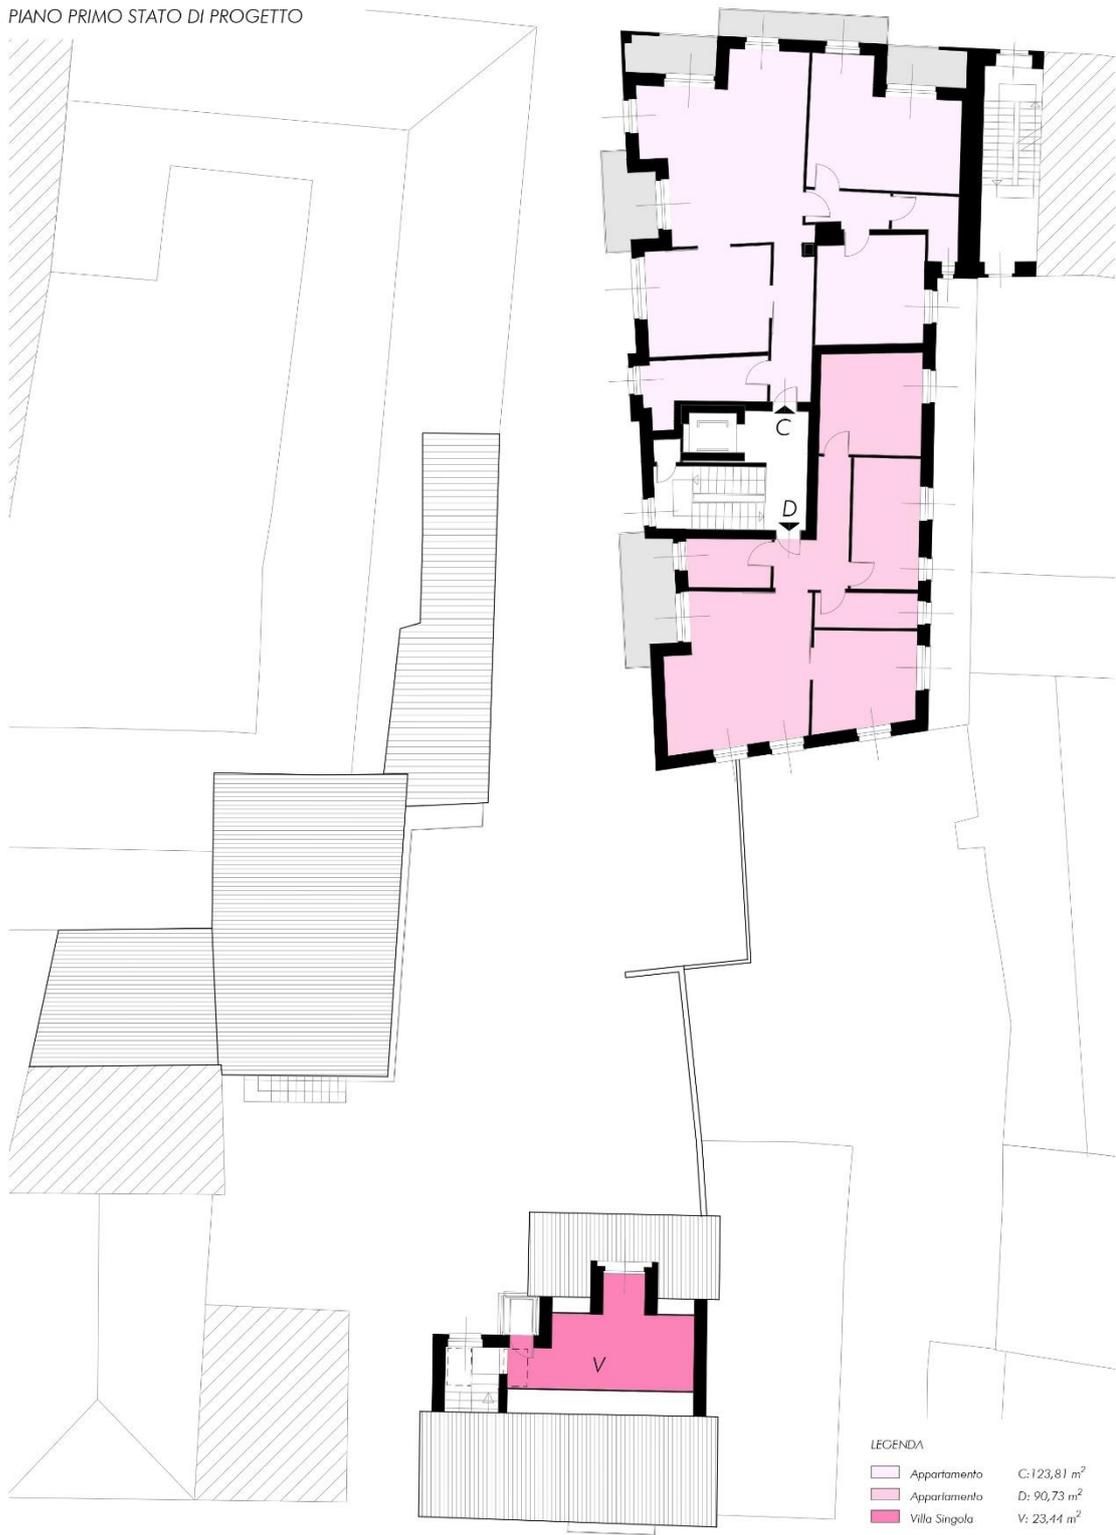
Suddivisione spazi funzionali all'interno del complesso condominiale Stato di Progetto
